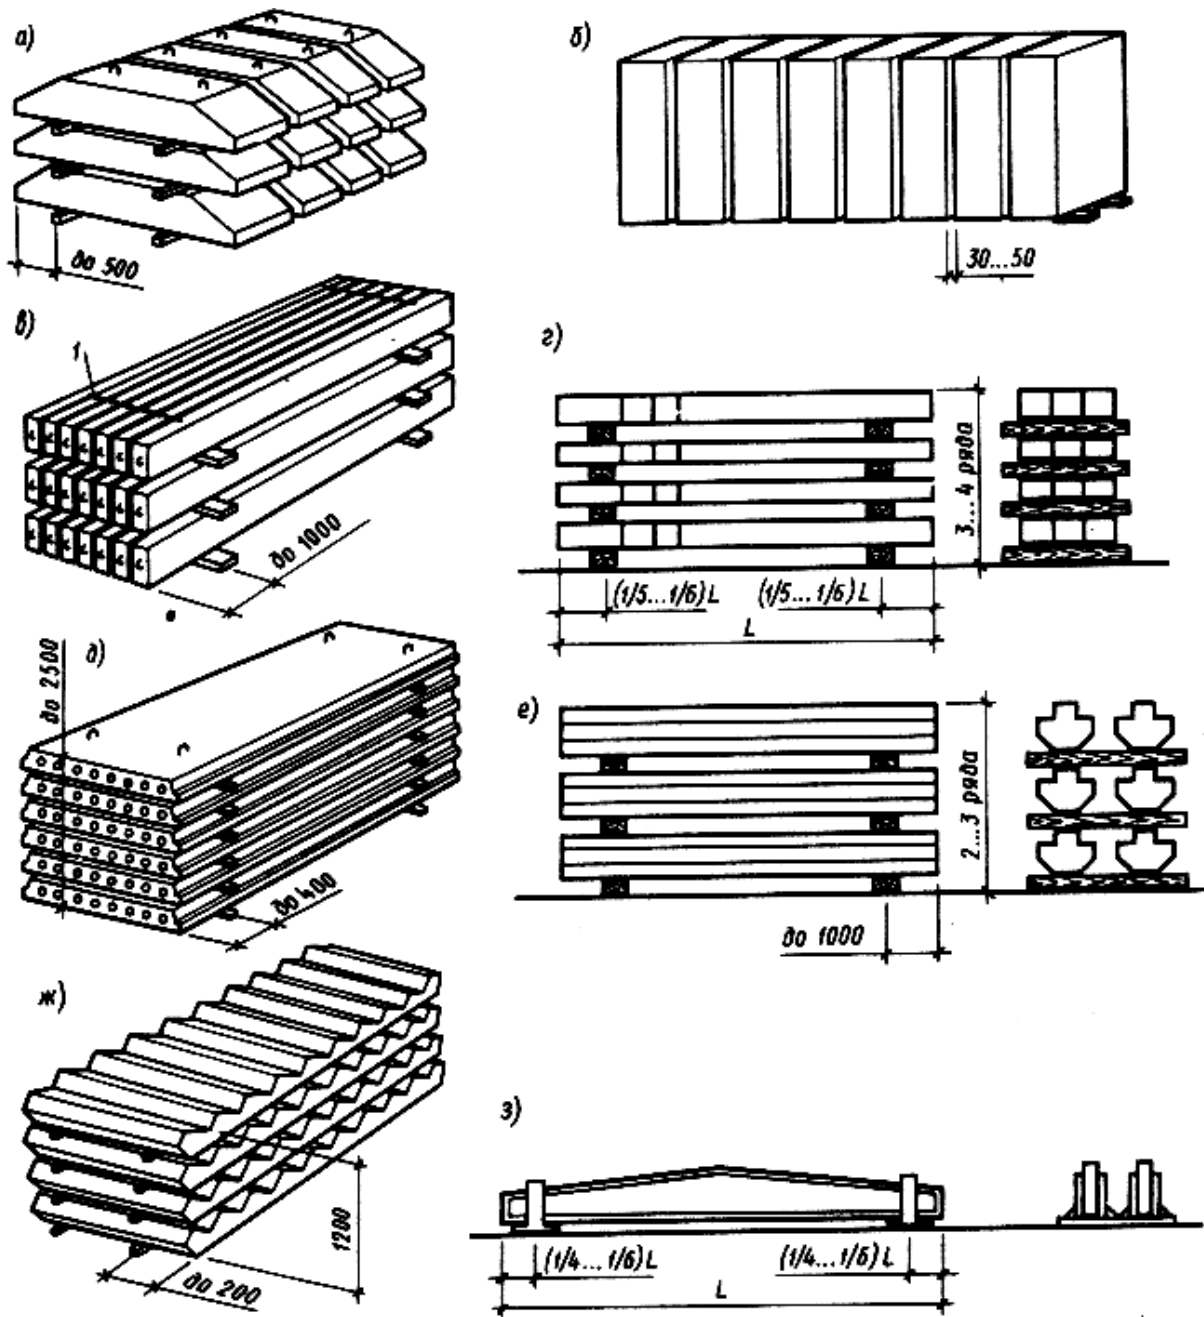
Складування збірних залізобетонних конструкцій:
